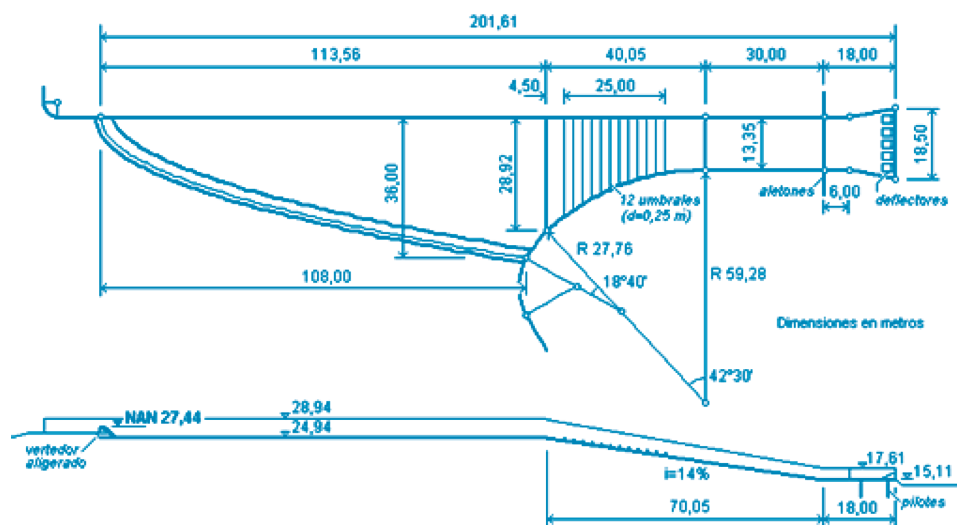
Baracoa: Planta y Perfil del Aliviadero.
